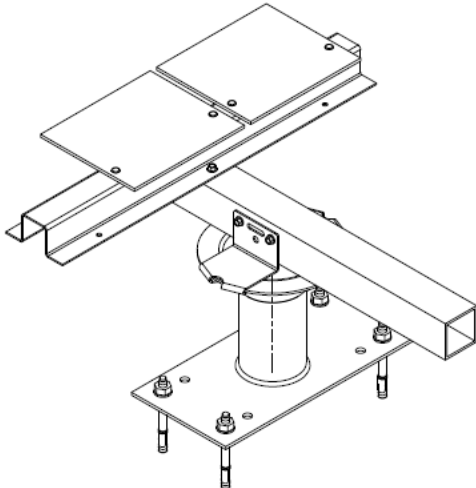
V1: Punkthalter für Dachpaneele, Beton und Trapezblech
